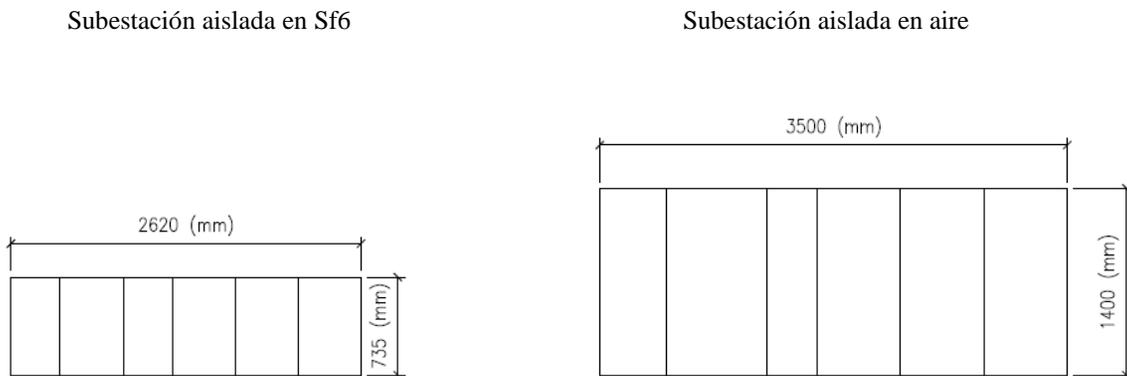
Vista de planta subestaciones aislada en Sf6 y aire
